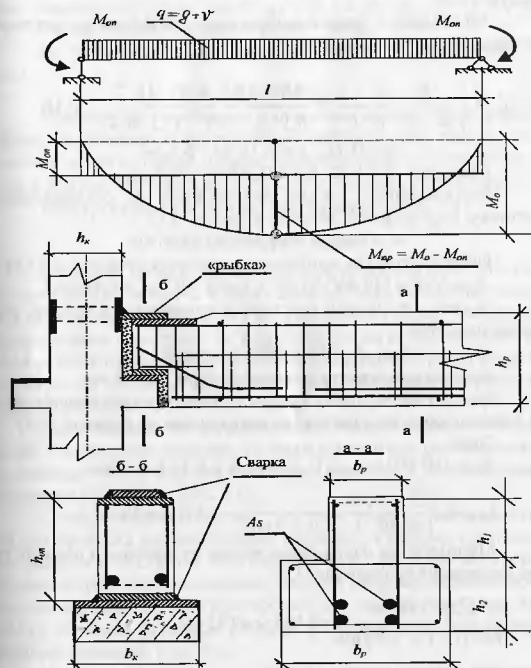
К расчету шарнирного стыка ригеля с колонной на «рыбке»
